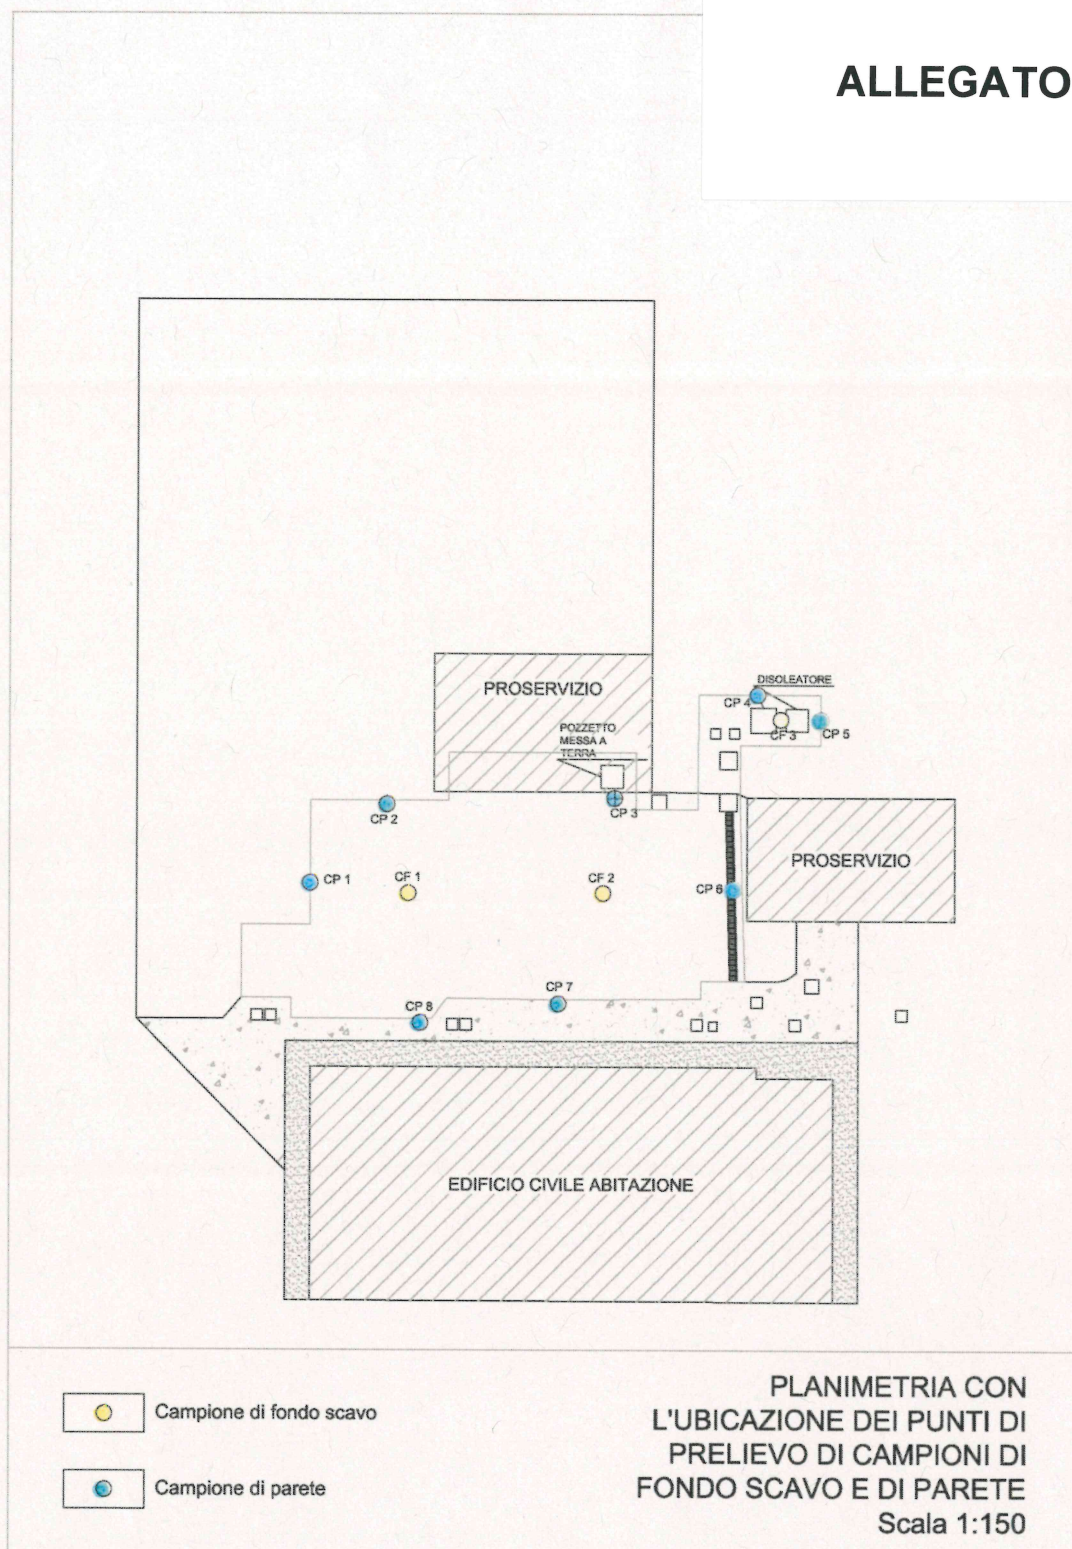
Planimetria con ubicazione dei campioni di fondo scavo e di parete
